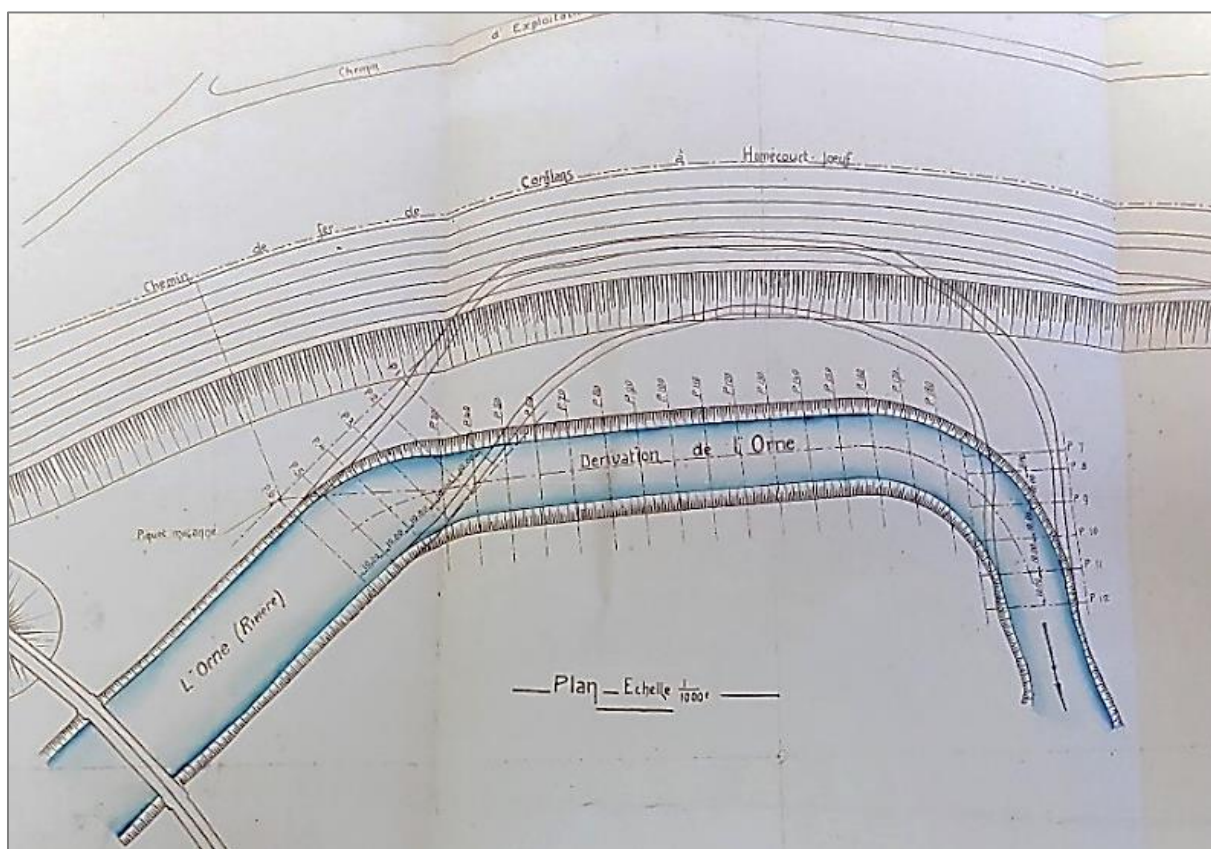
Plan de dérivation de l'Orne 1. Ce plan de la dérivation est joint à la demande au préfet du département de Meurthe et Moselle par la société anonyme des hauts-fourneaux et fonderies de Pont-à-Mousson – 10 août 1907.
